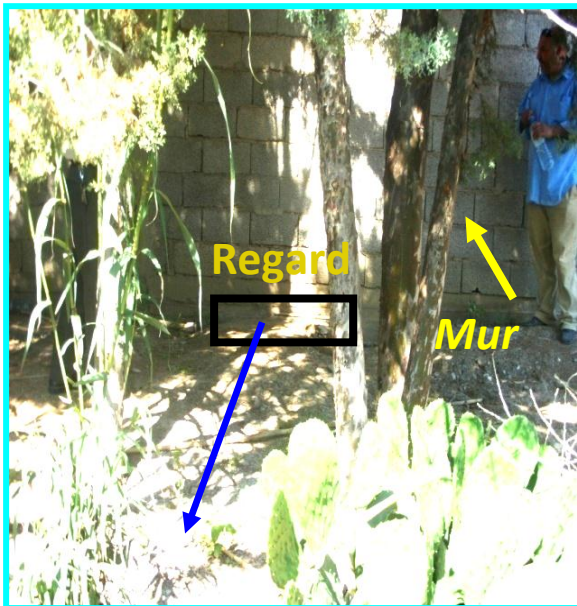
Mur entravant le cheminement du collecteur dans la cité Melh-Edab.
